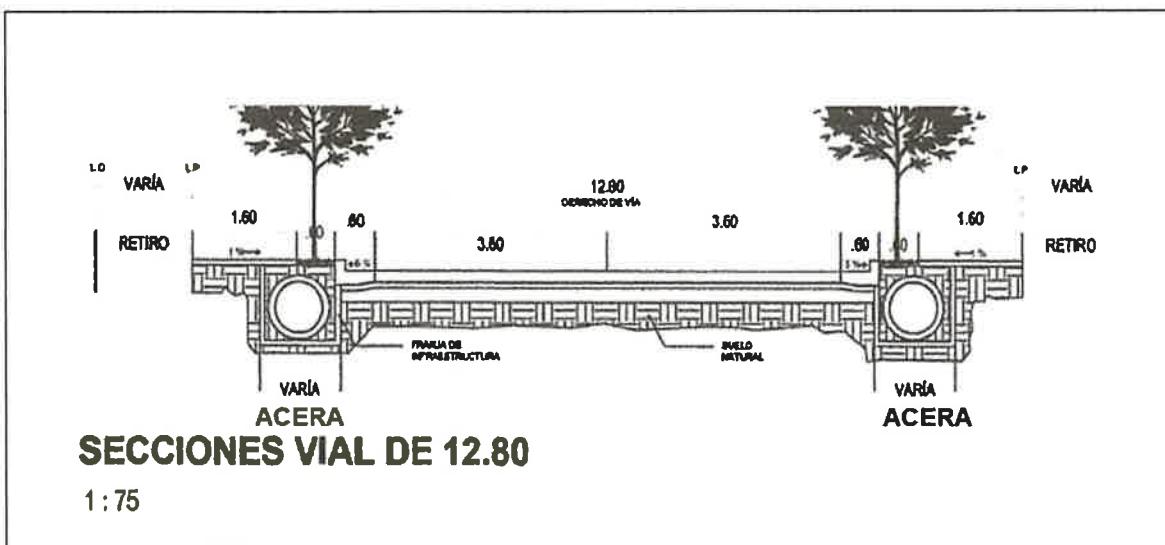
Sección de calle para la Lotificación Selva Primera fase
